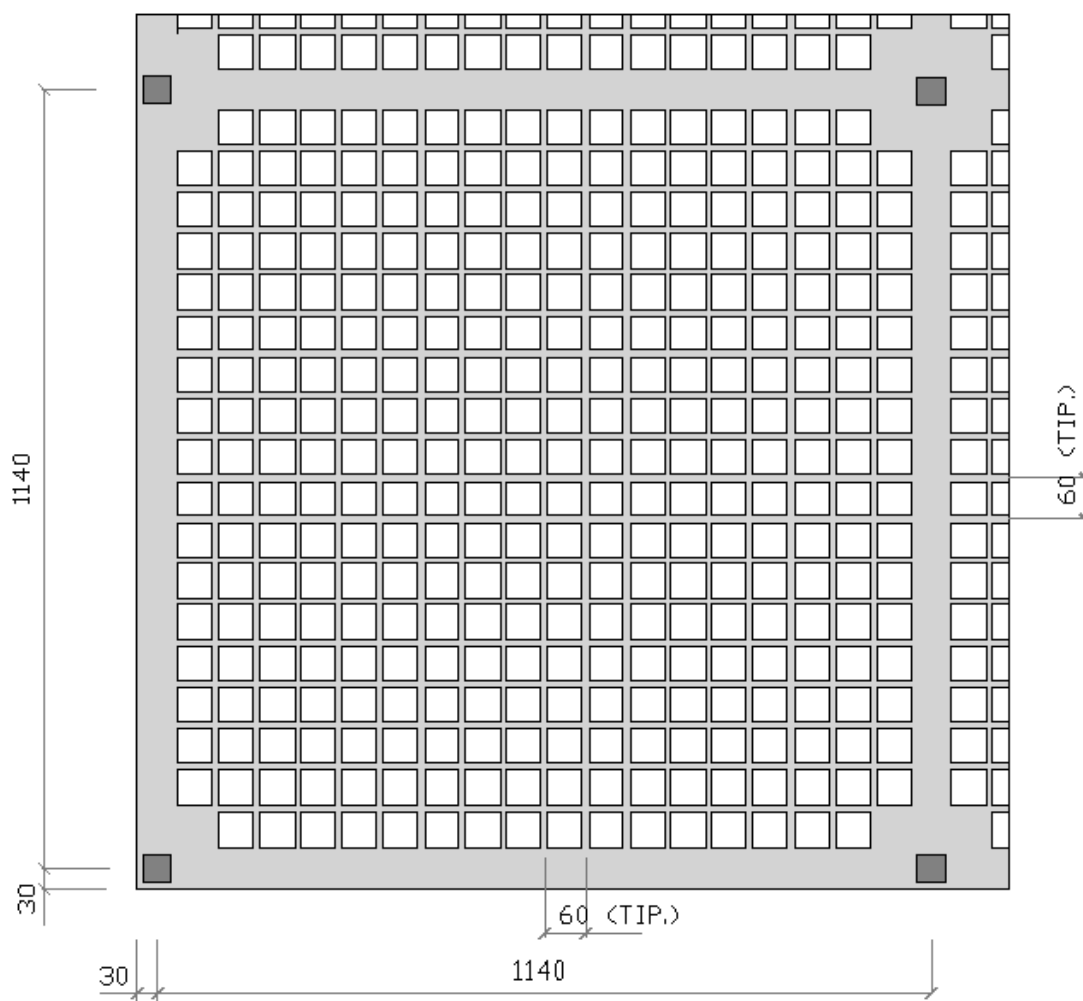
Laje nervurada com faixas de apoio – Planta. Dimensões em cm.
